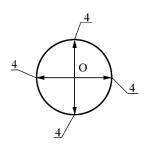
Разметка линии реза торцов трубопровода с применением приспособления
